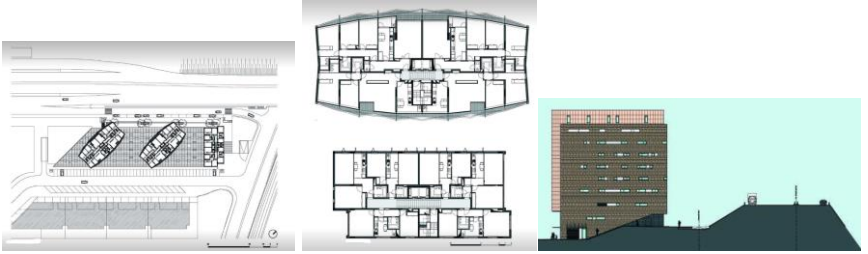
Projenin vaziyet planı ve kat planı (Url 6, 2016)
